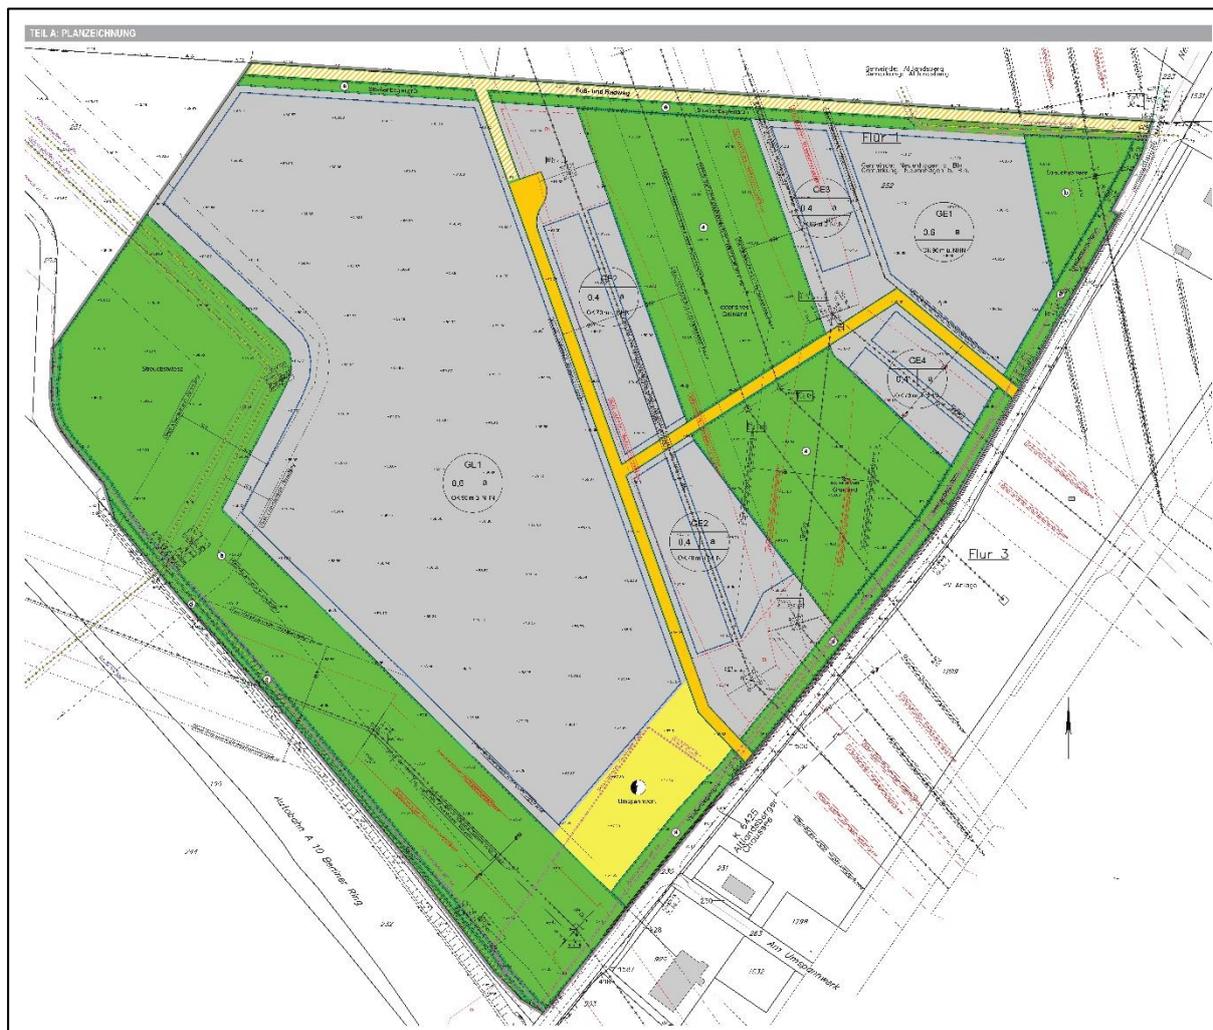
Planzeichnung des Bebauungsplans „Gewerbegebiet an der Altlandsberger Chaussee“
